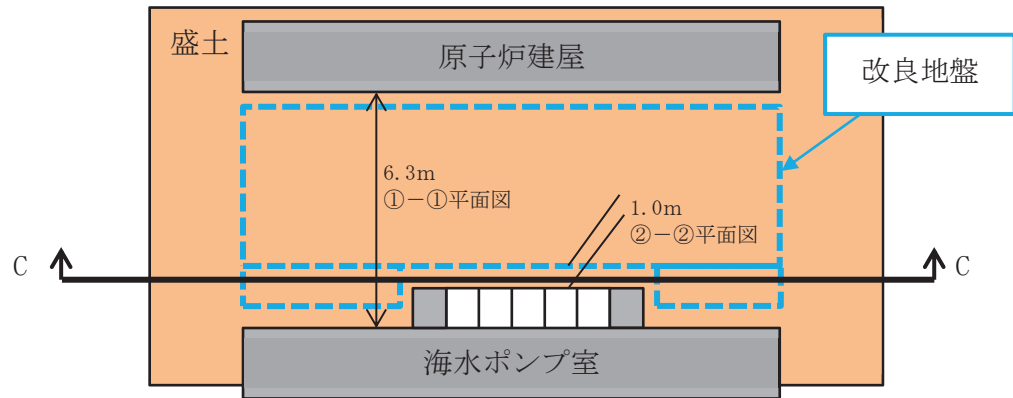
海水ポンプ室～原子炉建屋間の模式平面図
